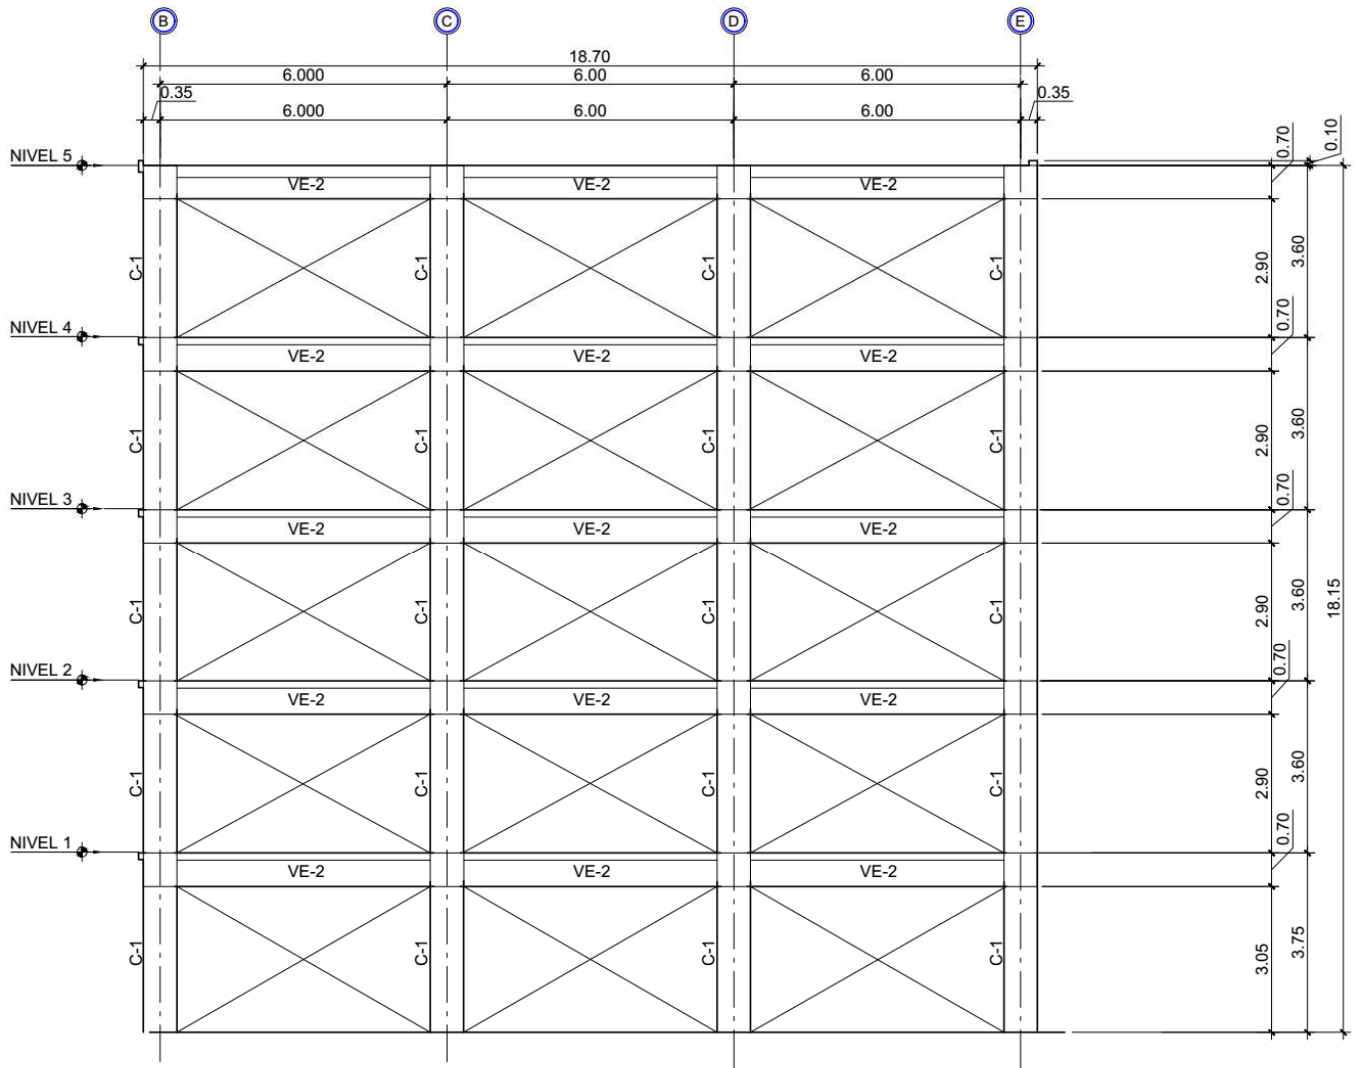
Elevación longitudinal a lo largo del eje 1 (dimensiones en metros)
